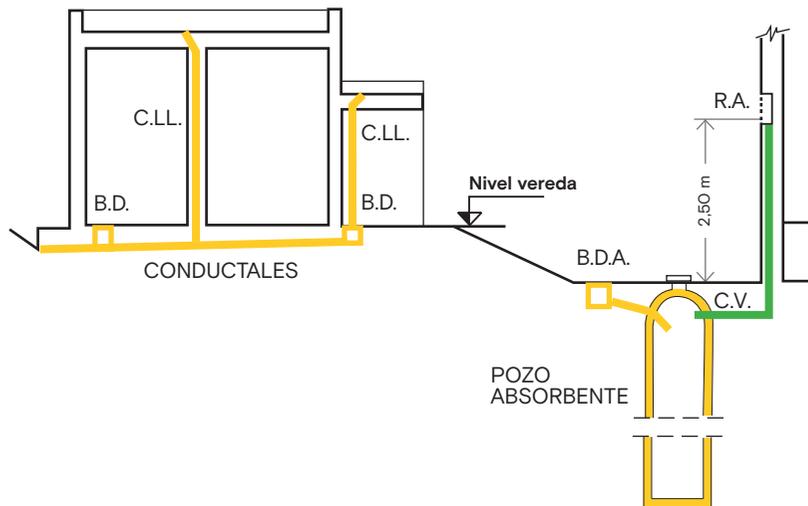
Pozo absorbente pluvial. Fuente: Manual de Obras Sanitarias de la Nación.
